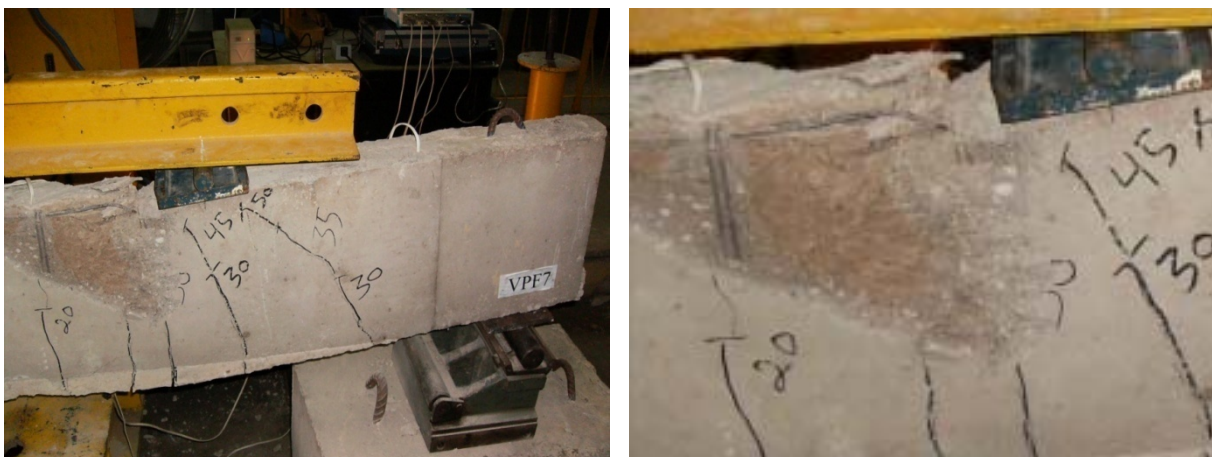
Camadas de concreto da viga VPF7 após a ruptura
